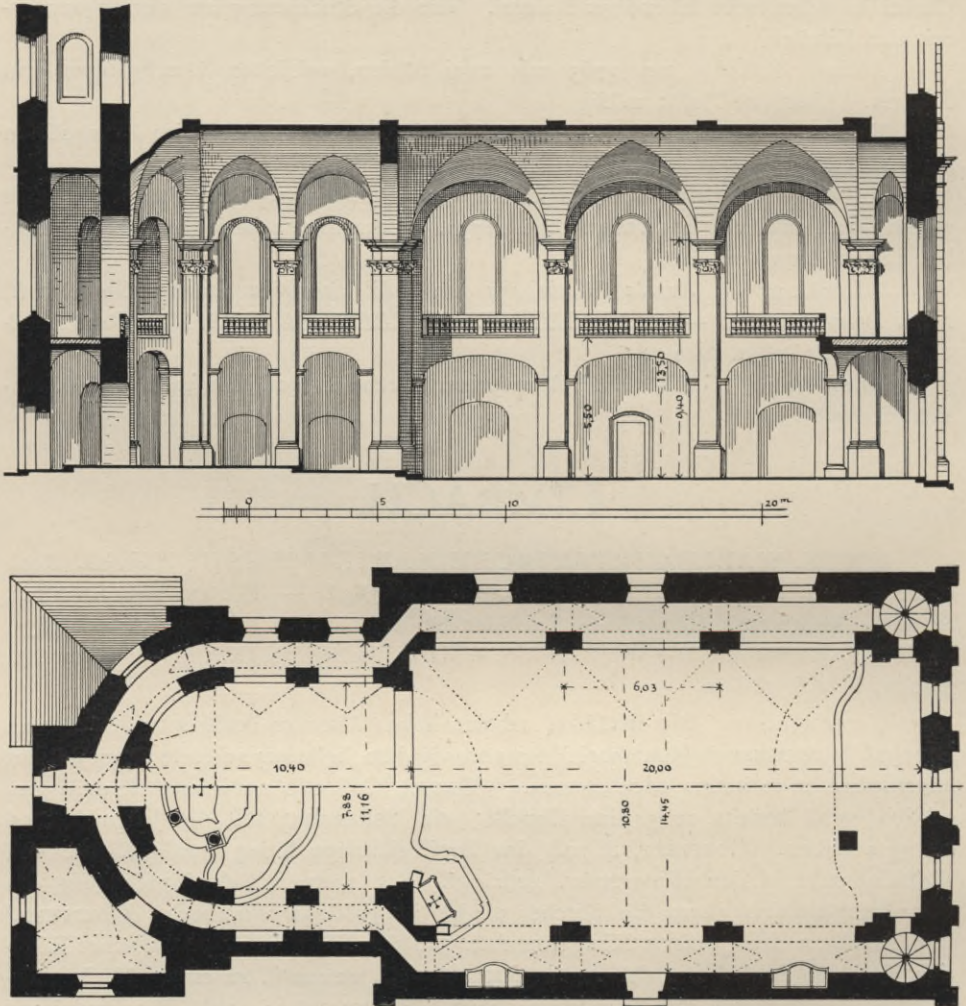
Limbach. Wallfahrtskirche. Grundriß und Schnitt.
